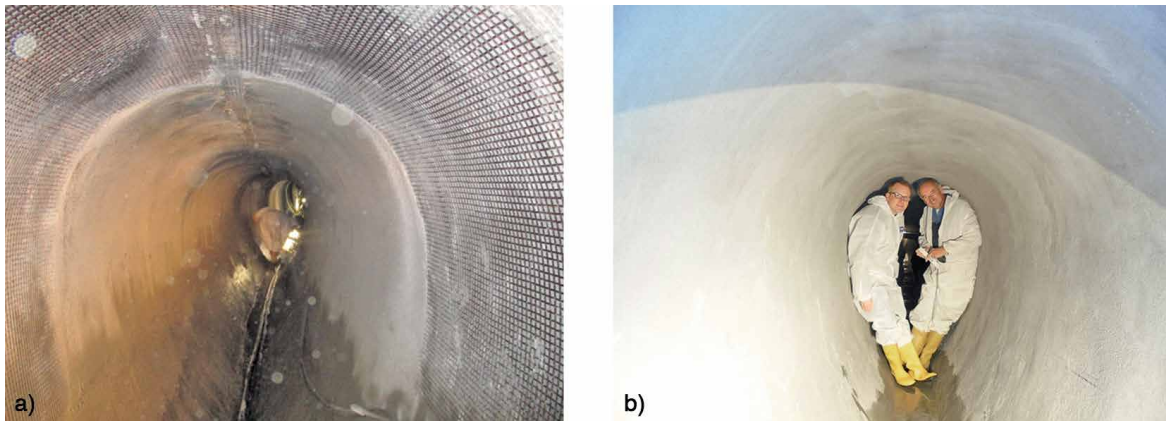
a) Auftrag Pagel TF10 Tudalit Feinbeton, b) geglättete Feinbetonoberfläche
